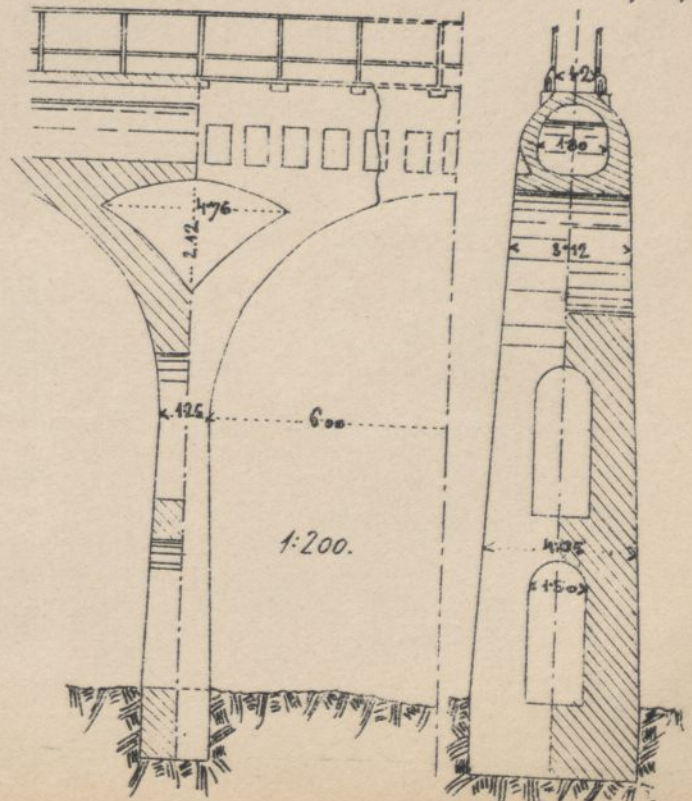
Przekrój podt. Rys. 3b. Widok. Rys. 3c. Przekrój poprzeczny.
